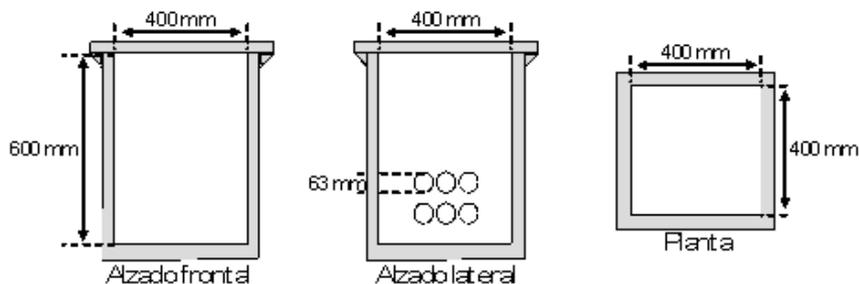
Alzados y planta de las arquetas de 400 × 400 × 600 mm.
